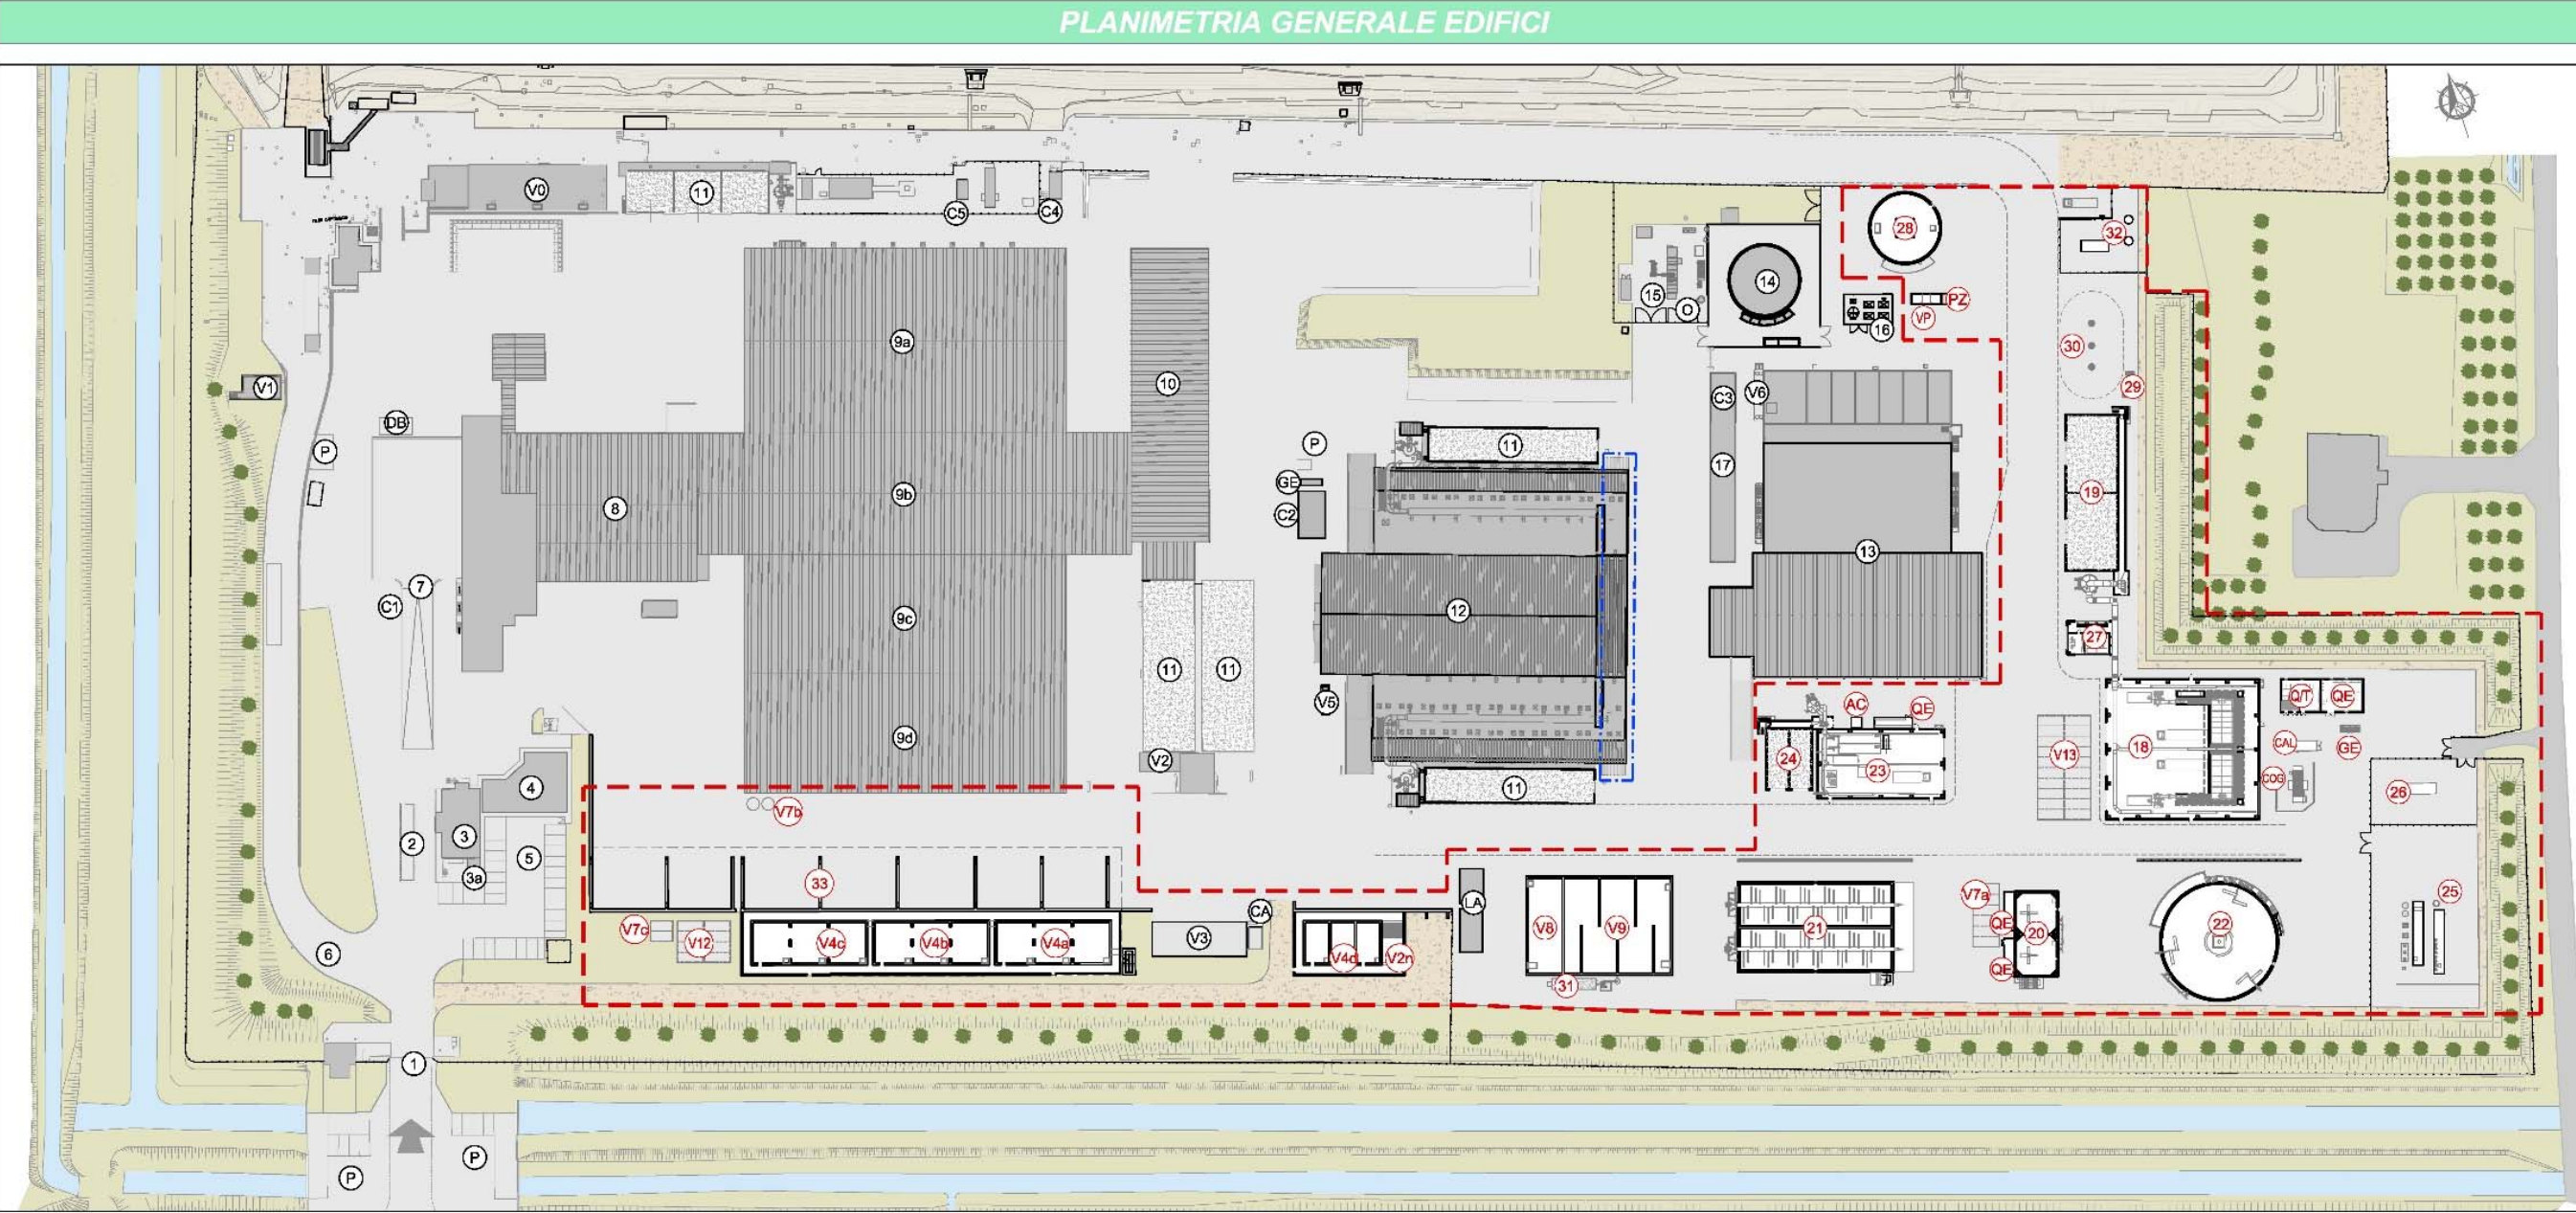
Estratto tavola ARC_002 - Planimetria con indicazione delle principali sezioni impiantistiche di progetto
